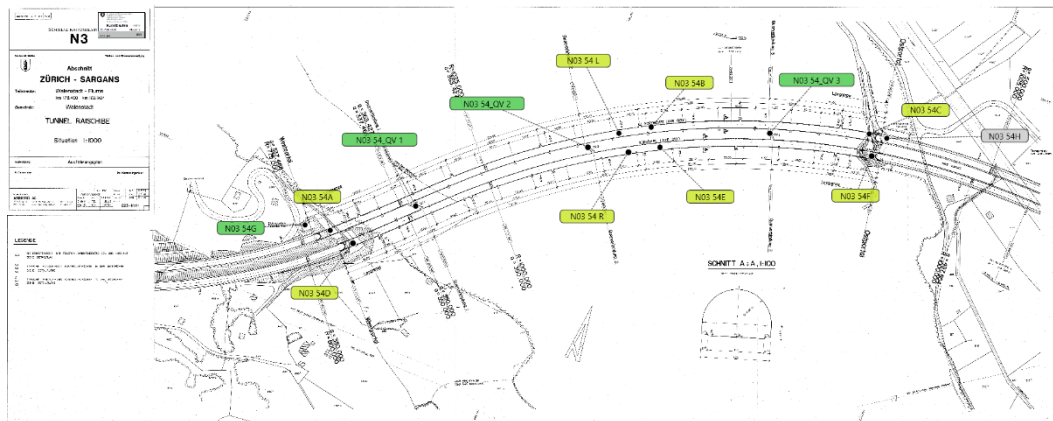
Situationsplan Tunnel Raischibe - Walenstadt
